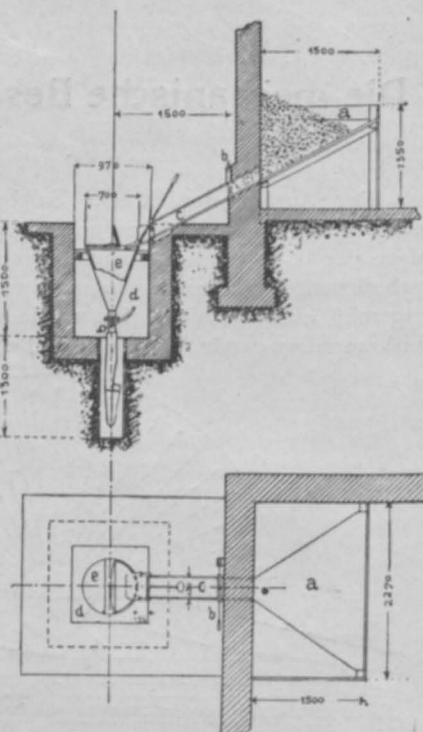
Sandtrichter, Auslauftrichter und Grube mit Sandtrichter (Schnitt A—B in Abb. 4).
